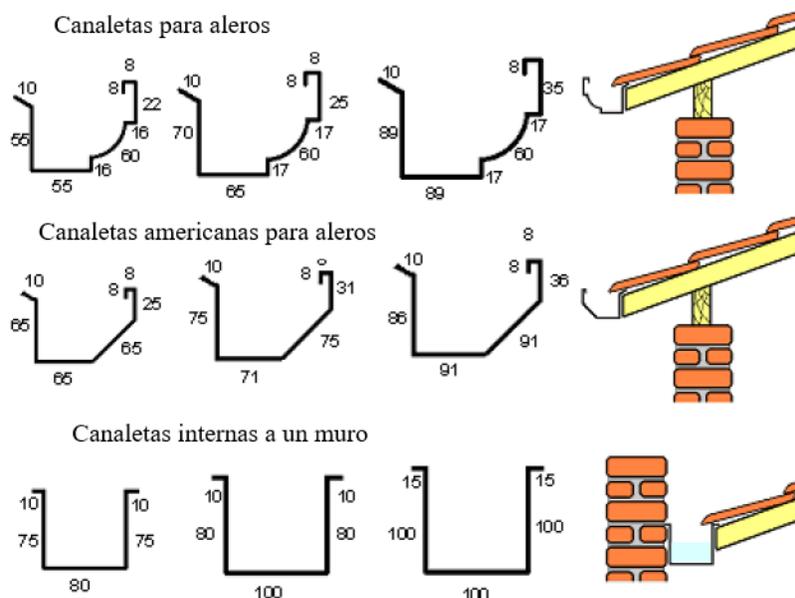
Secciones de canaletas (PCC, 2018)
